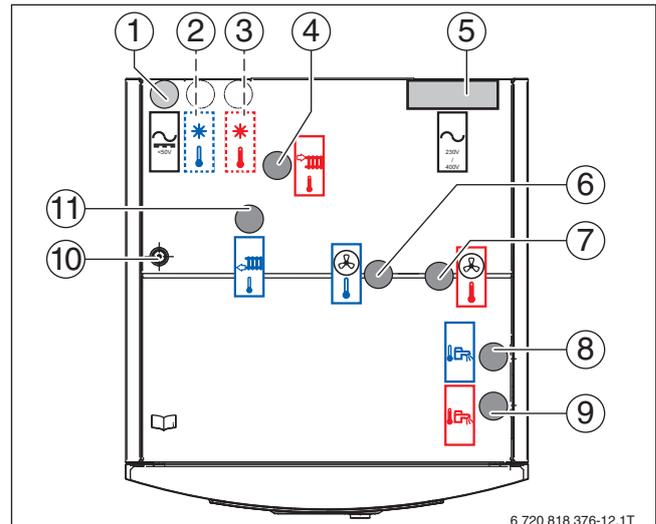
Rohranschlüsse IDU W8/W14 T/TS (Draufsicht)
